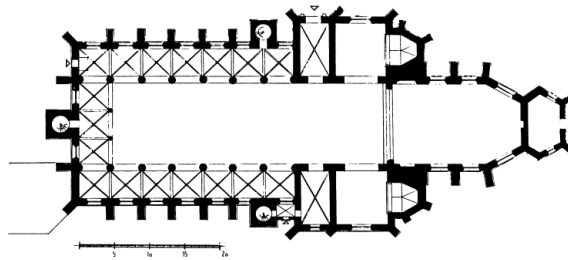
Molsheim, Jesuitenkirche. Grundriss (Jesuitenkirche 1982, Abb.21)
